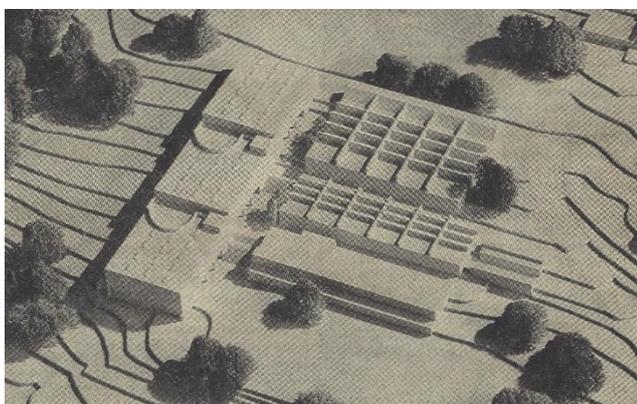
Modellansicht des ursprünglichen Schulhausprojekts Egler 1973
